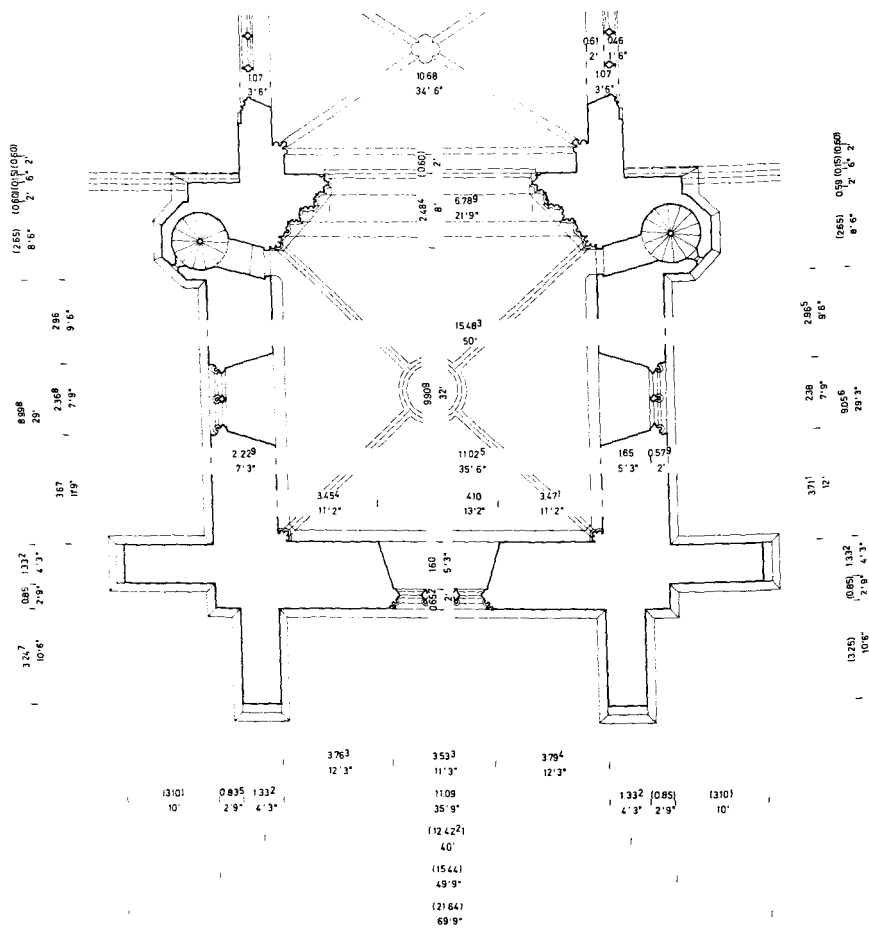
Freiburg Münsterturm, Grundriß Michaelsgeschoß.
